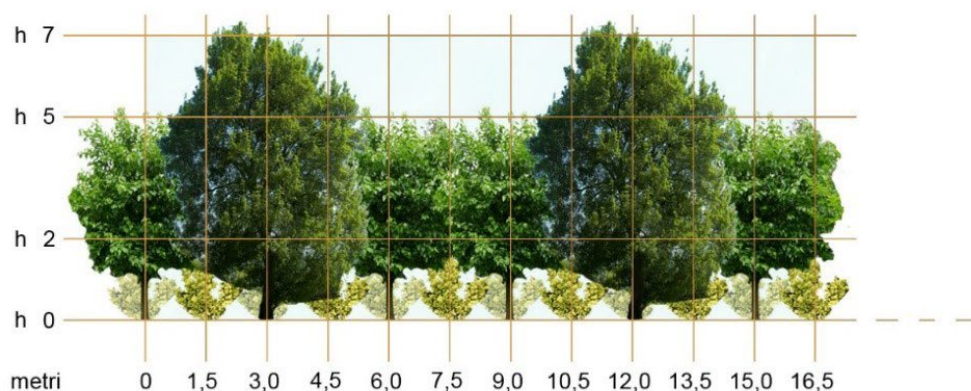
Schema d'impianto planimetrico dell'area campione A - fascia di mitigazione Sez. A-A'
